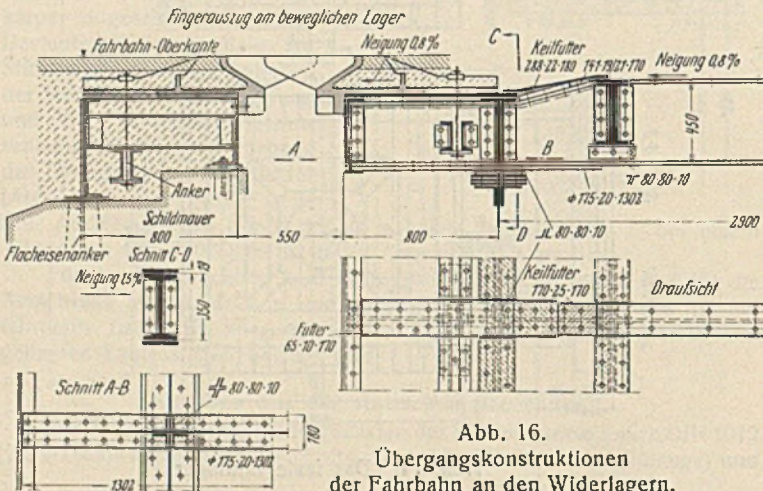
Übergangskonstruktionen der Fahrbahn an den Widerlagern.
